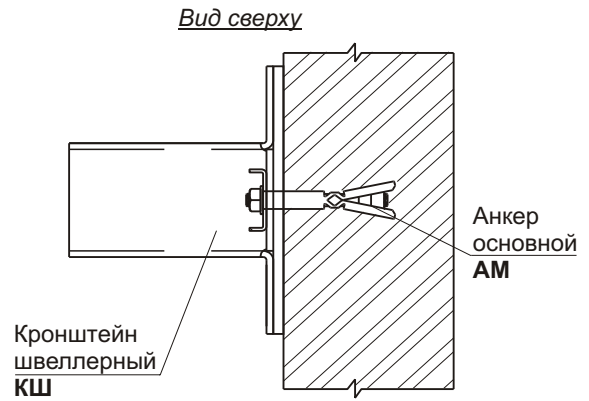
Крепление кронштейна КШ к стене одним основным анкером
